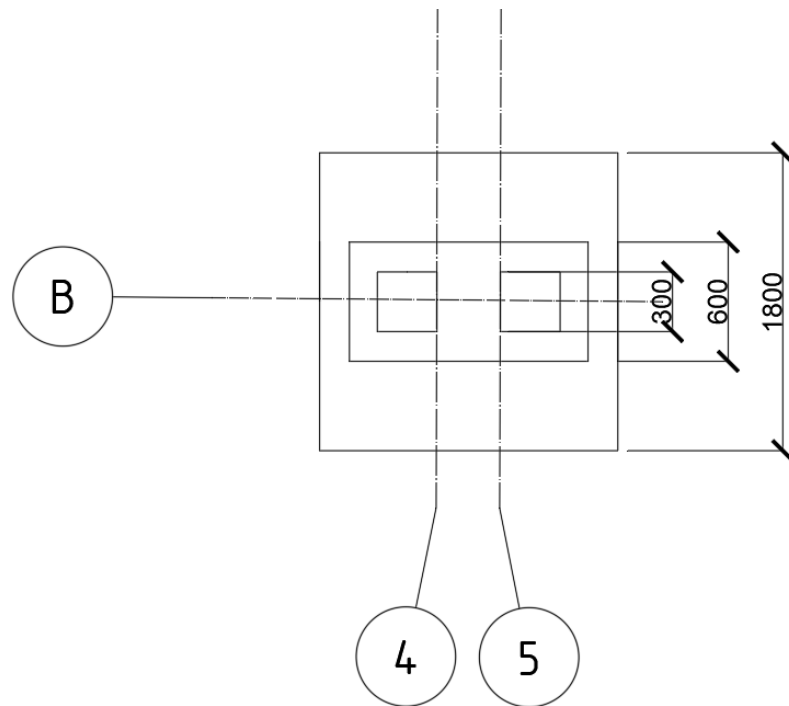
Схема столбчатого фундамента Ф-2, вид сверху.
